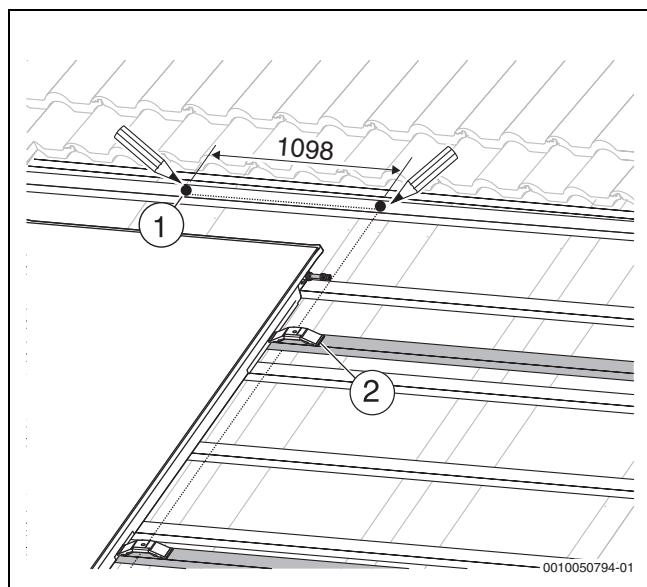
Posizione di montaggio dell'elemento di collegamento superiore per collettori orizzontali
